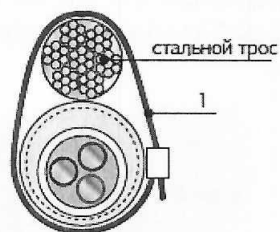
Крепление к тросу с помощью кабельных стяжек
